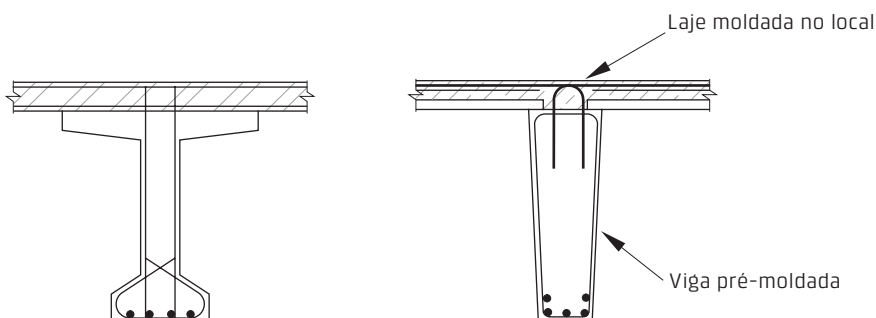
Seção transversal típica de viga pré-moldada com laje moldada no local
